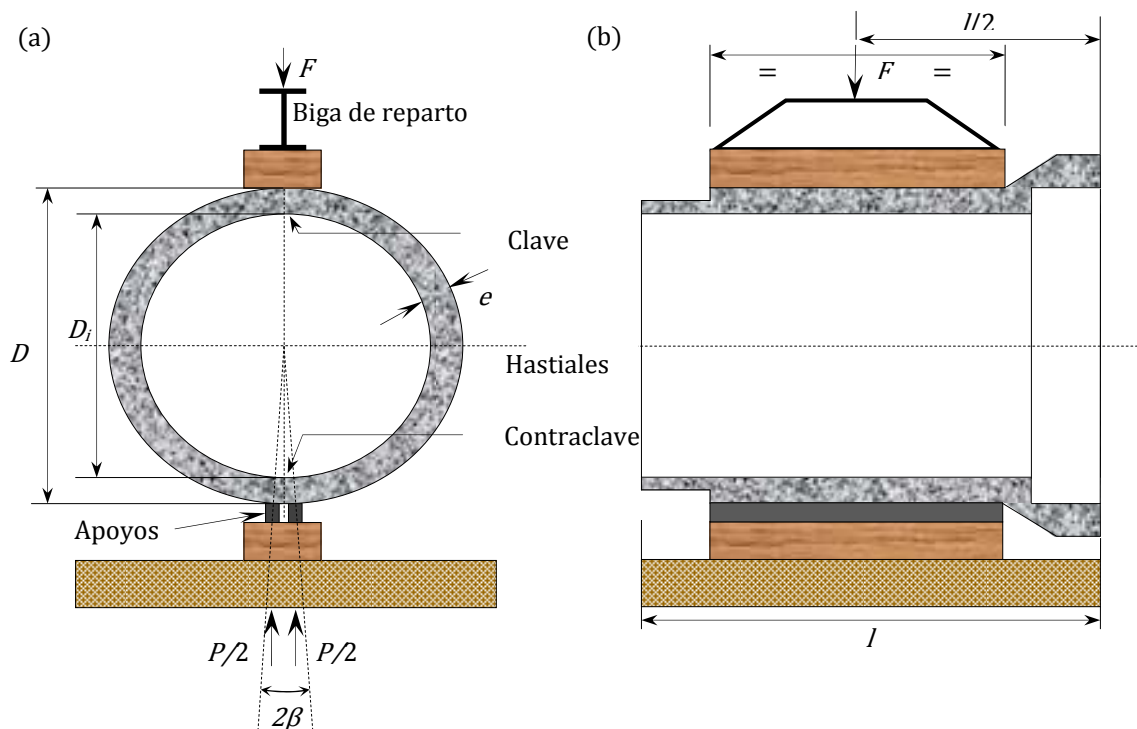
(a) Sección transversal y (b) sección longitudinal del EA.
